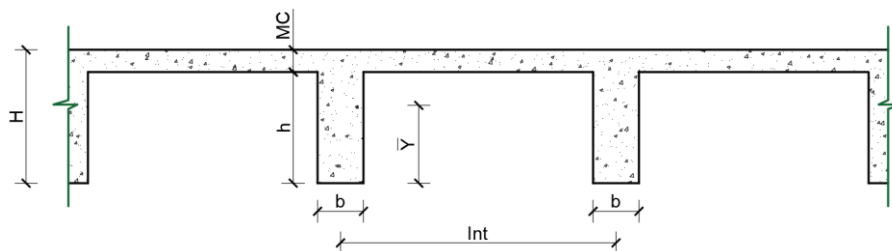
Detalle Sección Transversal Losa Reticular H=25cm.
